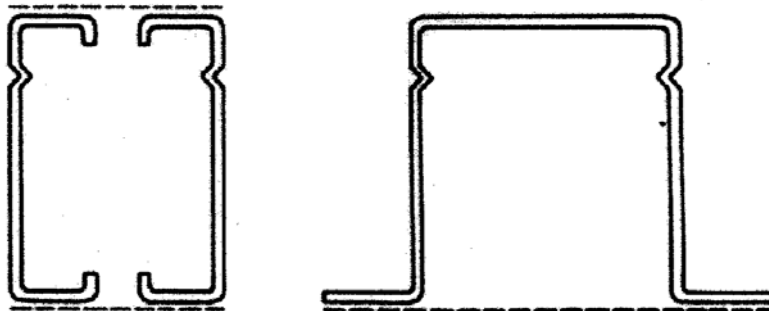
Secciones típicas para secciones de vigas con atiesadores longitudinales.
